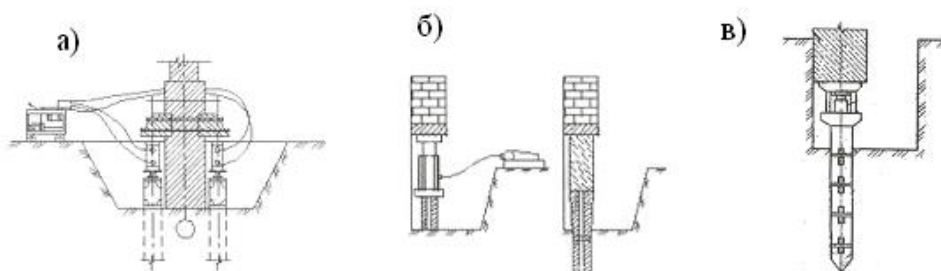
Усиление фундаментов с использованием коротких свай вдавливанием:
